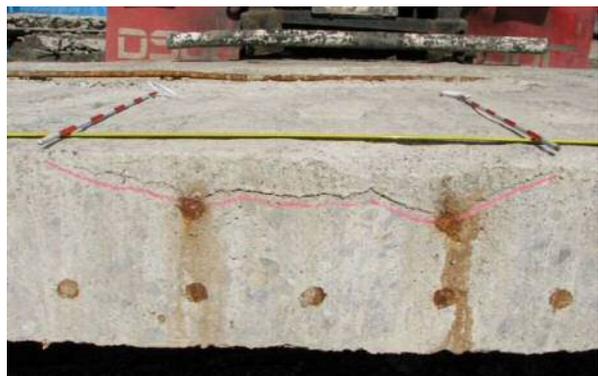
上縁鉄筋に沿った水平ひび割れ
